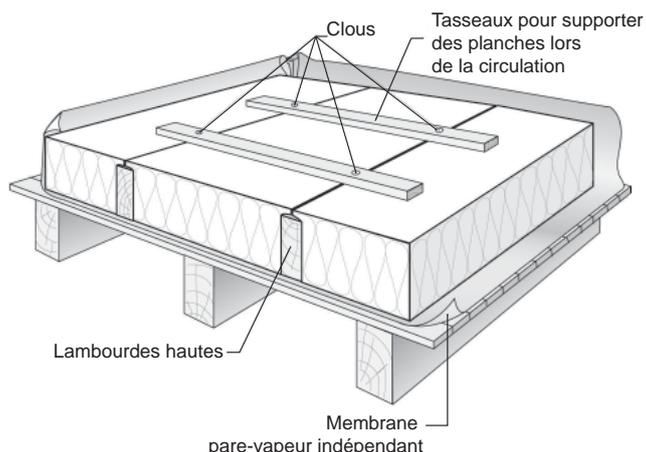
Isolation en combles sur plancher bois : panneaux posés bord à bord
